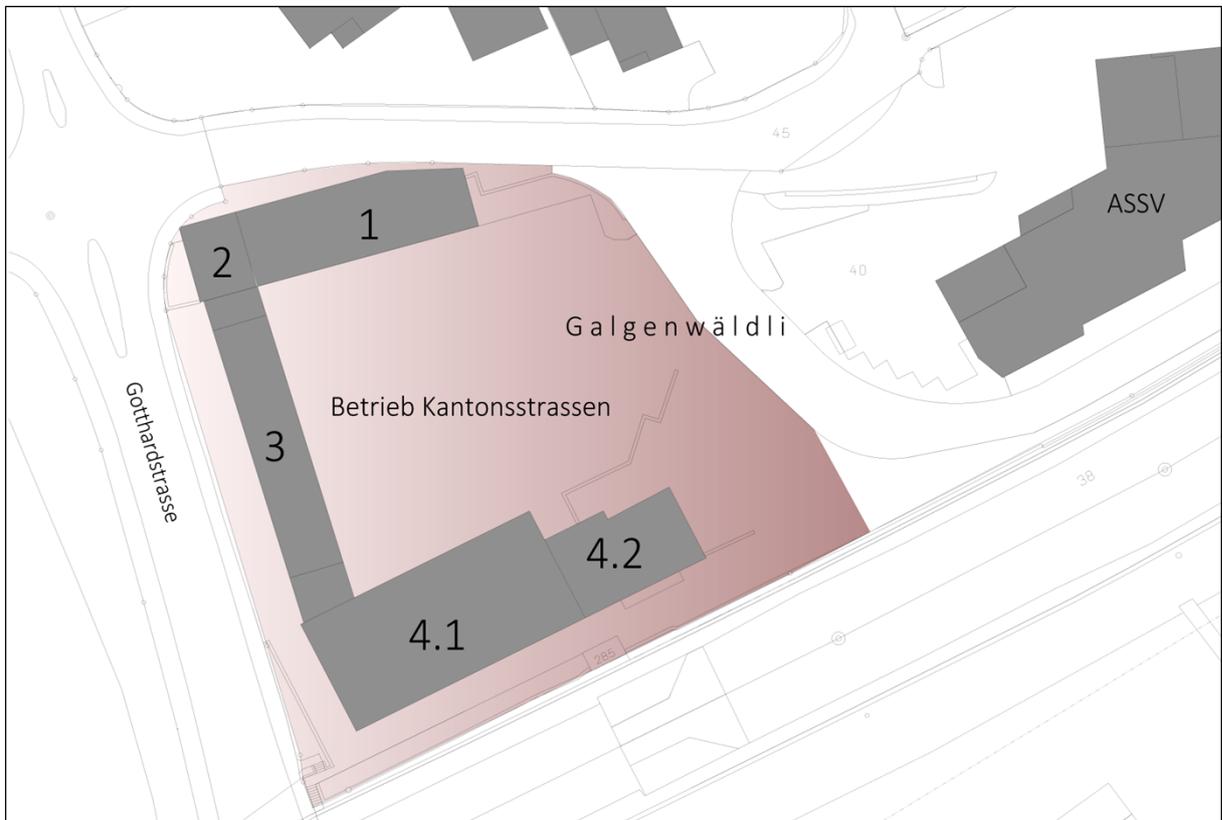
Übersichtsplan Parzelle mit den fünf Gebäuden.
